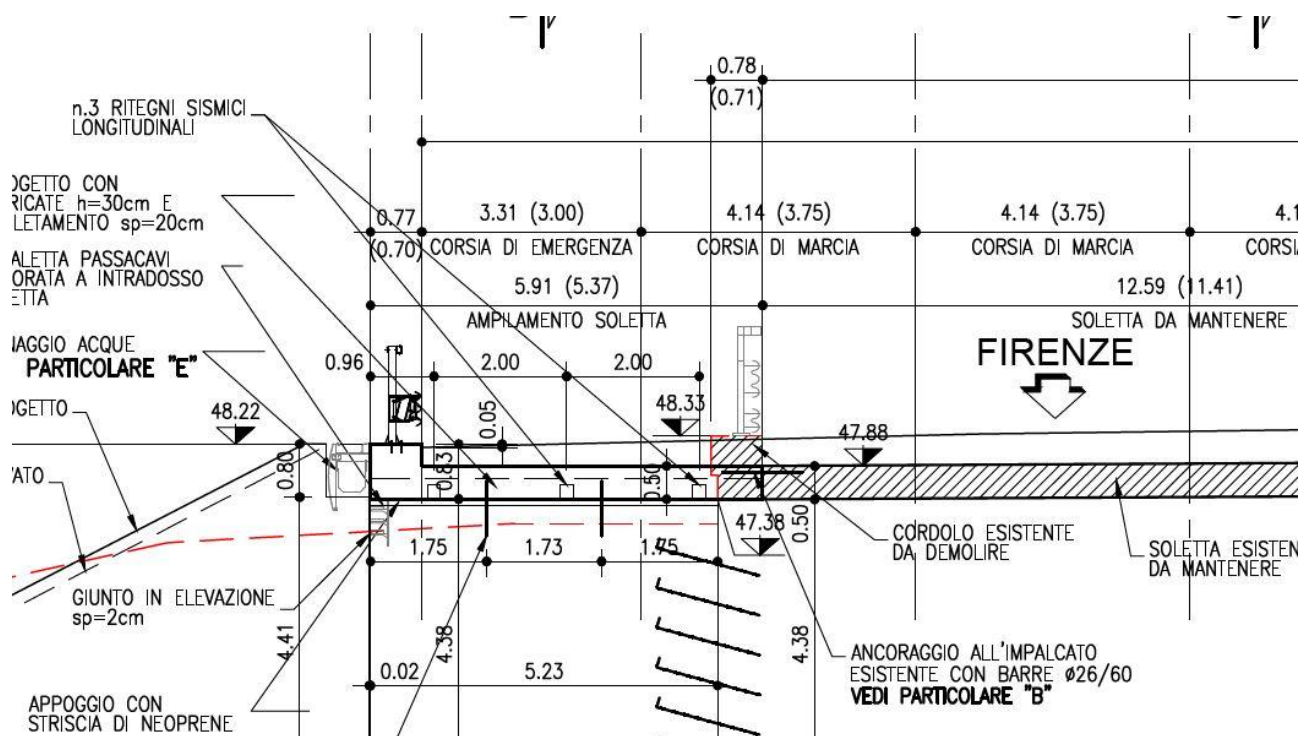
Sezione tipo struttura di sostegno in allargamento.
